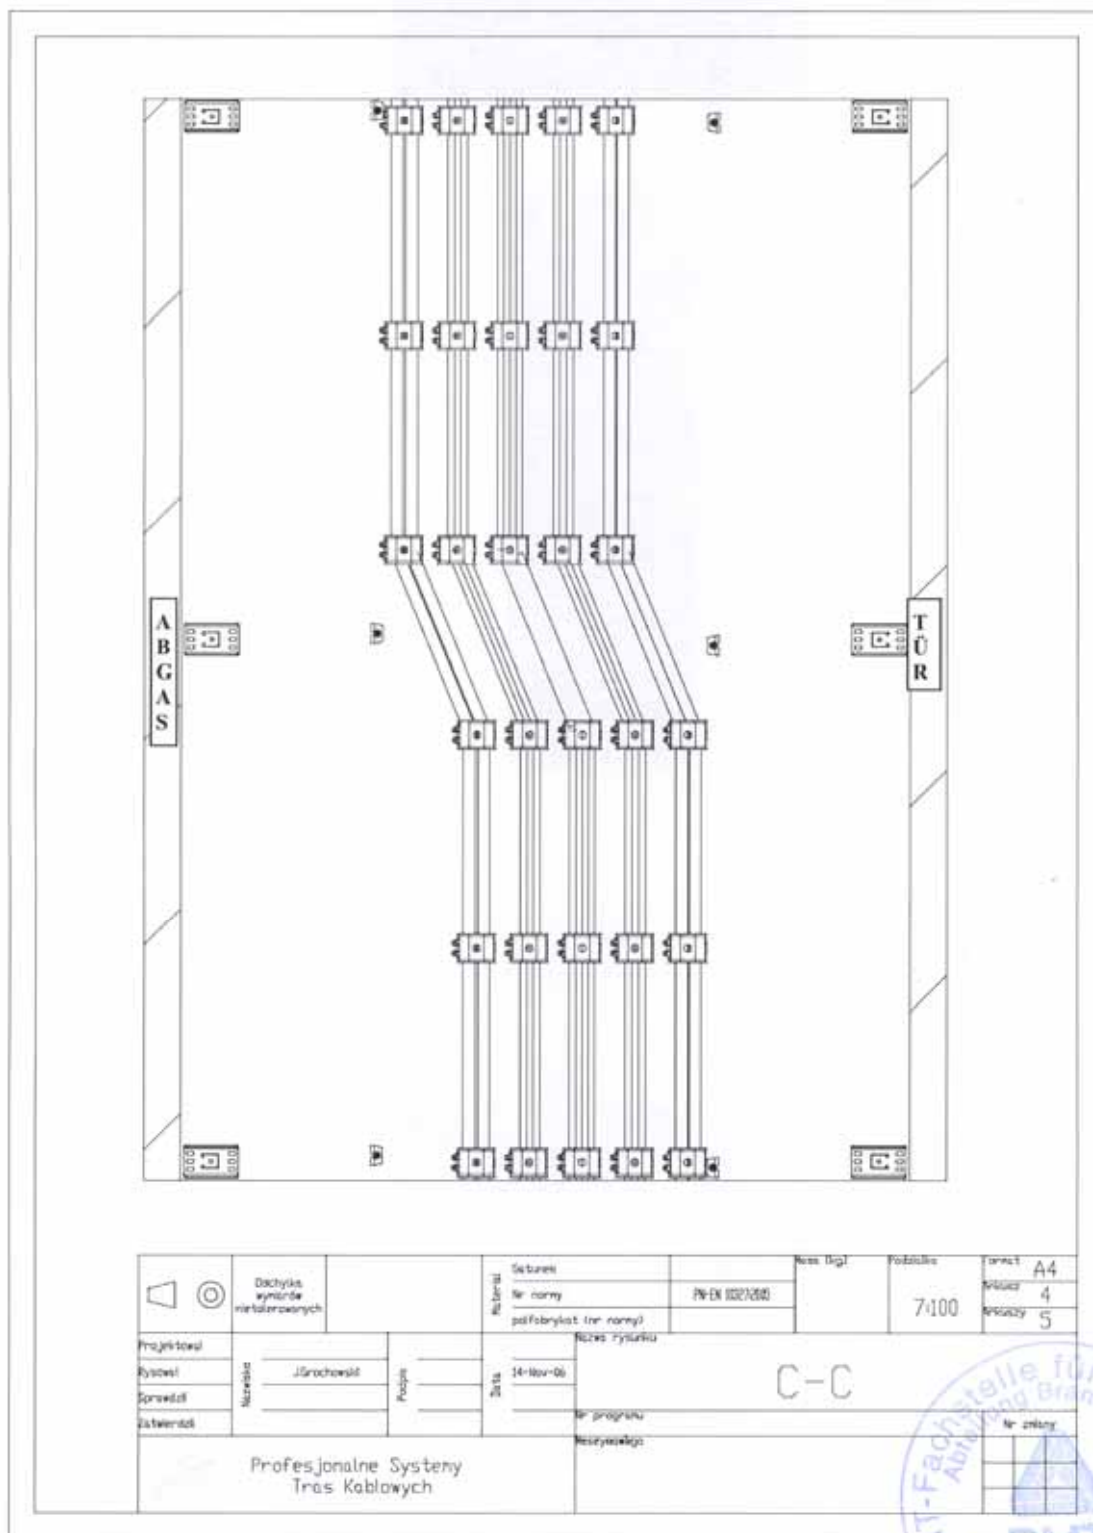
Grundriss der montierten Tragsysteme
